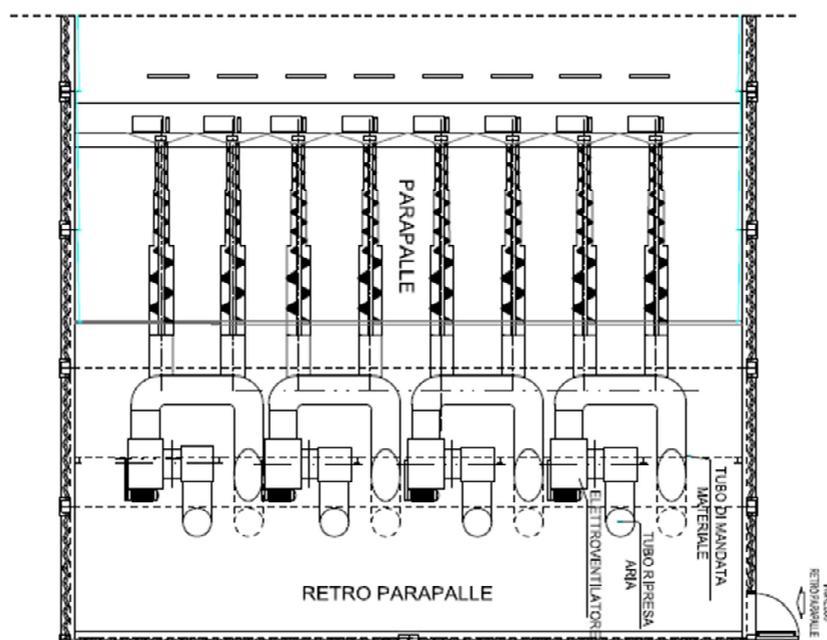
Pianta schematica di un parapalle ad assorbimento
